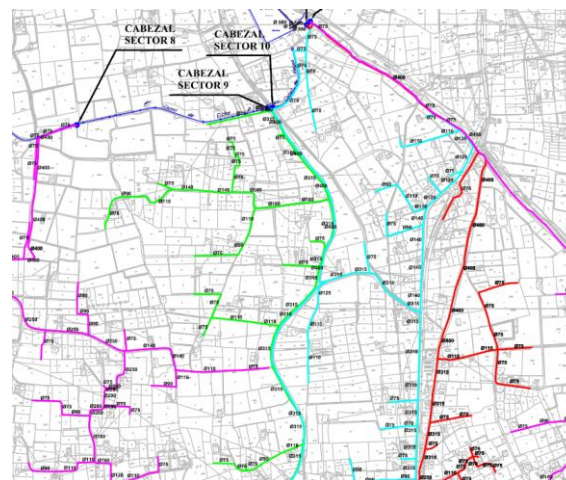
Imagen parcial de trazado de las redes de distribución de los Sectores 8, 9 y 10 del Primer Canal de Levante. Fuente: Proyecto de modernización Primero de Levante S1 al S12 (sept 2005)
